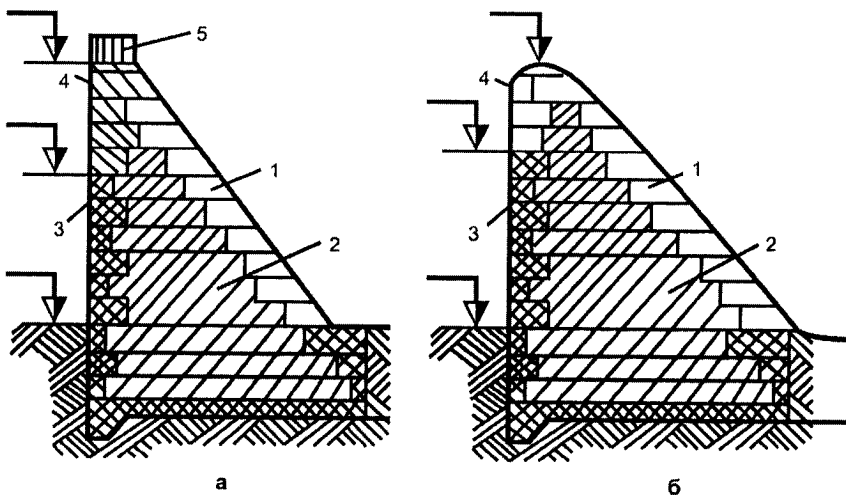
Схеми гребель: а – глуха гребля; б – водозливна гребля; 1 – бетон зовнішньої зони; 2 – внутрішньої зони; 3 – підводний; 4 – зони змінного рівня; 5 - надводний
